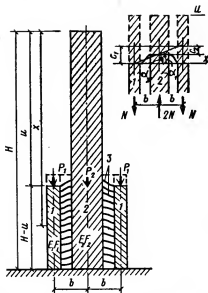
Условная расчетная схема каркасного здания с ядром жесткости
